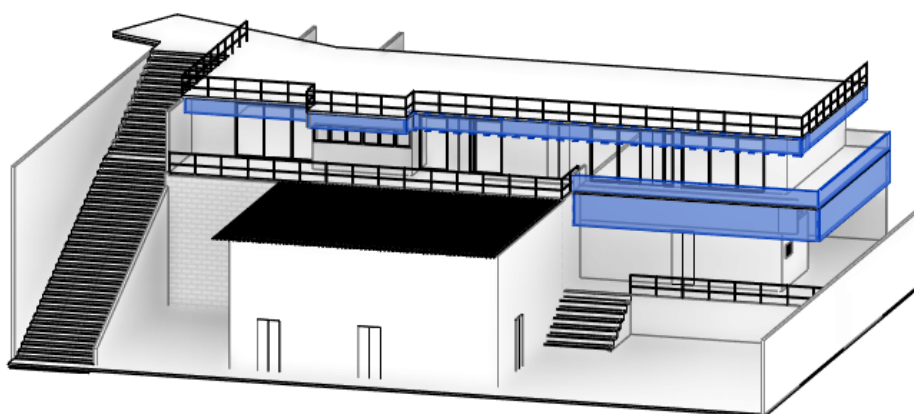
Vista frontal dos pontos de intervenção na fachada
